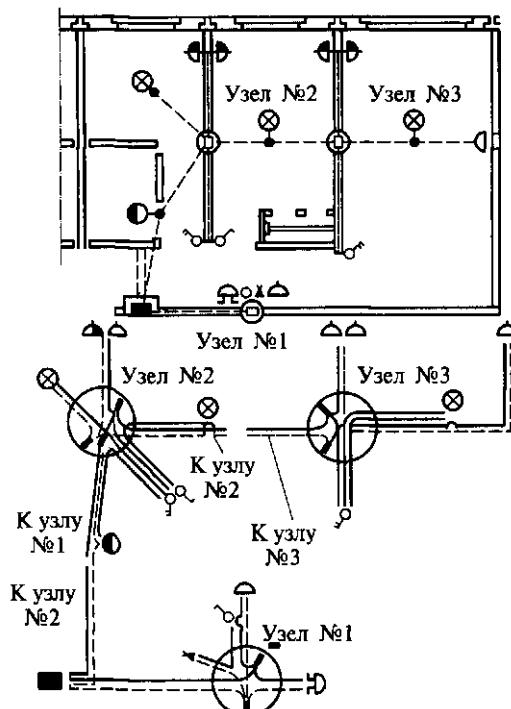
Пример технологической карты на монтаж электропроводки освещения, прокладываемой в каналах строительных конструкций здания
